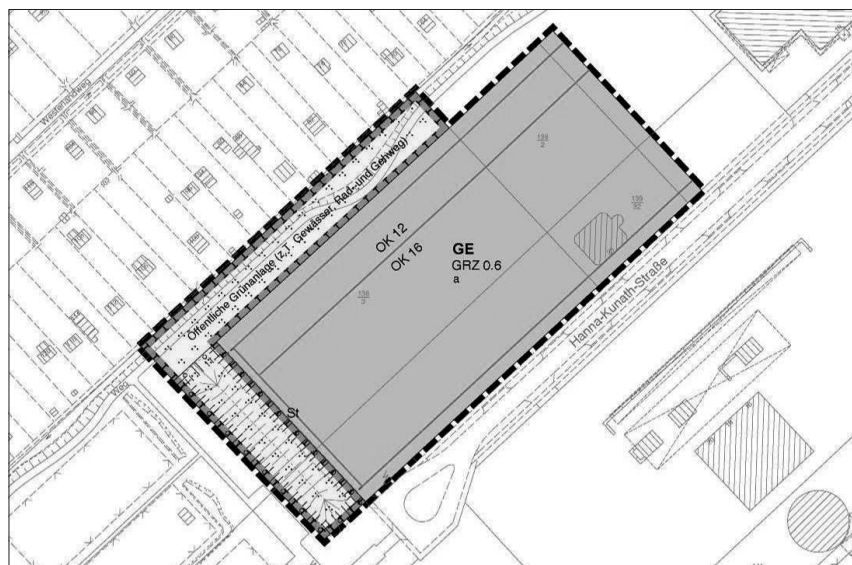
Planzeichnung Bebauungsplan Nr. 2192
